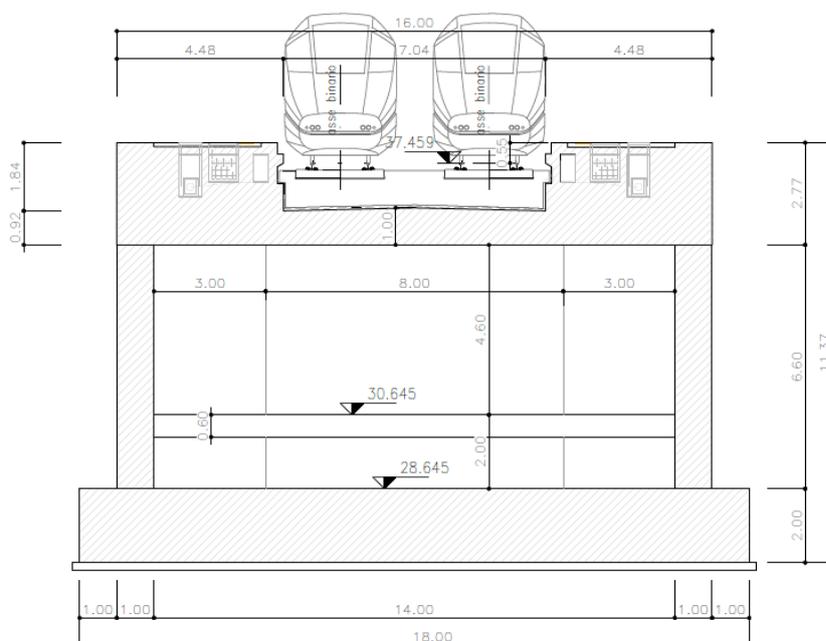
Scatolare di stazione – FV01: Sezione tipo
